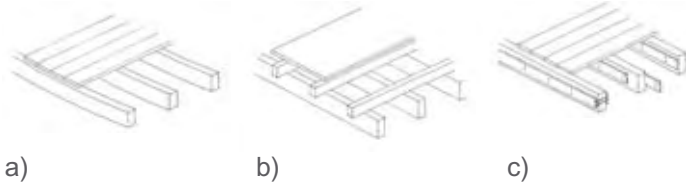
a),b) colocação de vigas transversais às vigas do pavimento; c) reforço de vigas por colocação de elementos metálicos.
